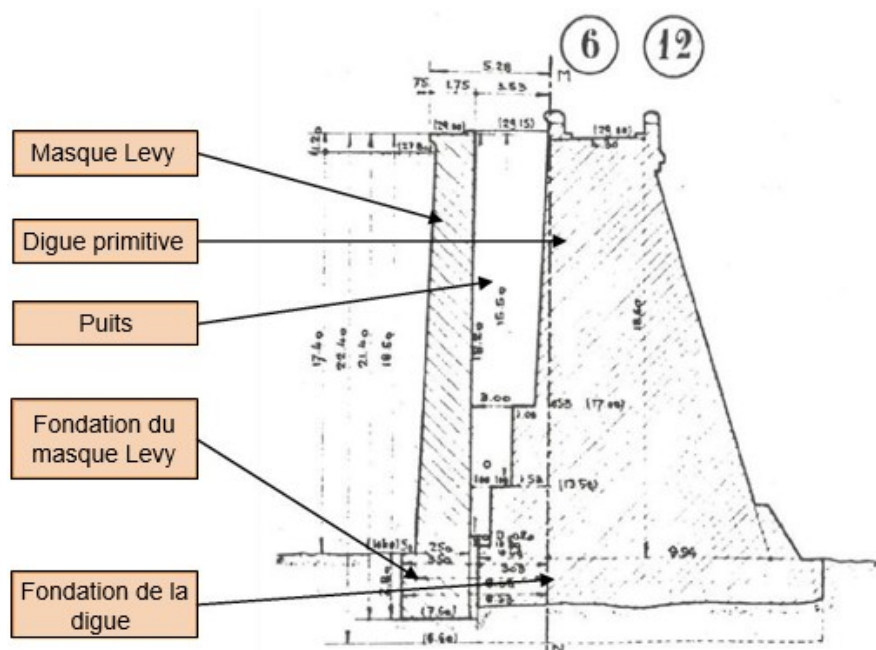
COUPE TYPE DU BARRAGE AVEC MASQUE LÉVY AU DROIT D'UN PUIITS PRENANT APPUI DIRECTEMENT SUR LA DIGUE PRIMITIVE (SOURCE : EDD - ISL)
